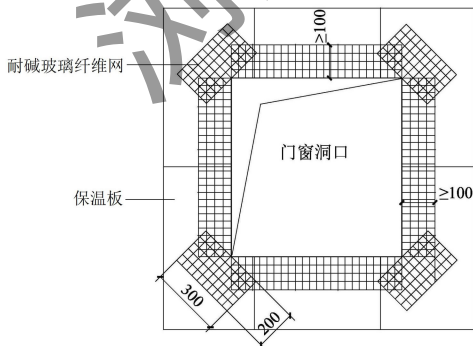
门窗洞口部位耐碱玻璃纤维网布增强示意图
